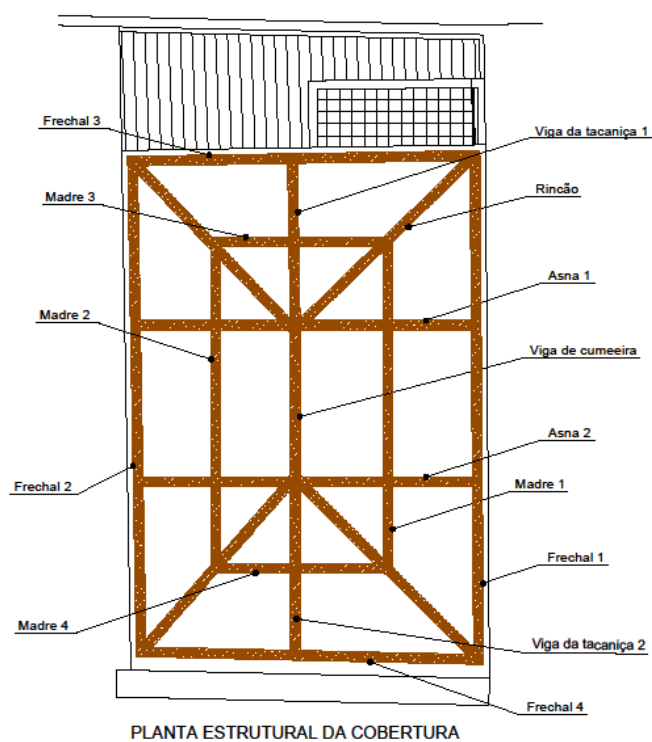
Planta estrutural da cobertura em madeira (antes)
